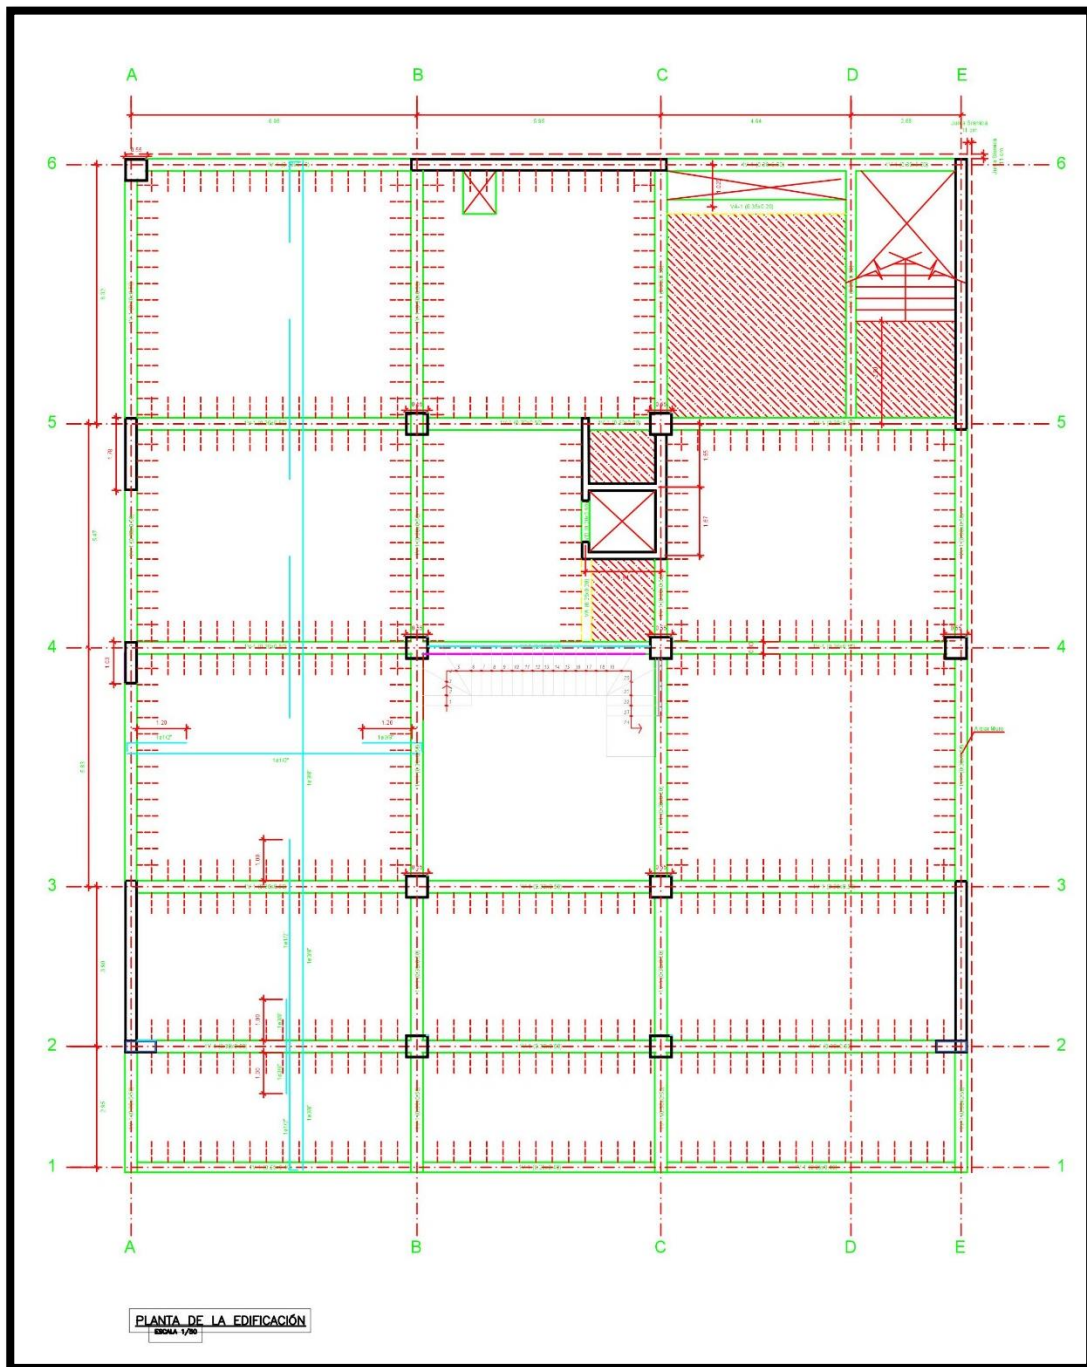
Plano en planta de la estructuración de la edificación de 10 niveles.
